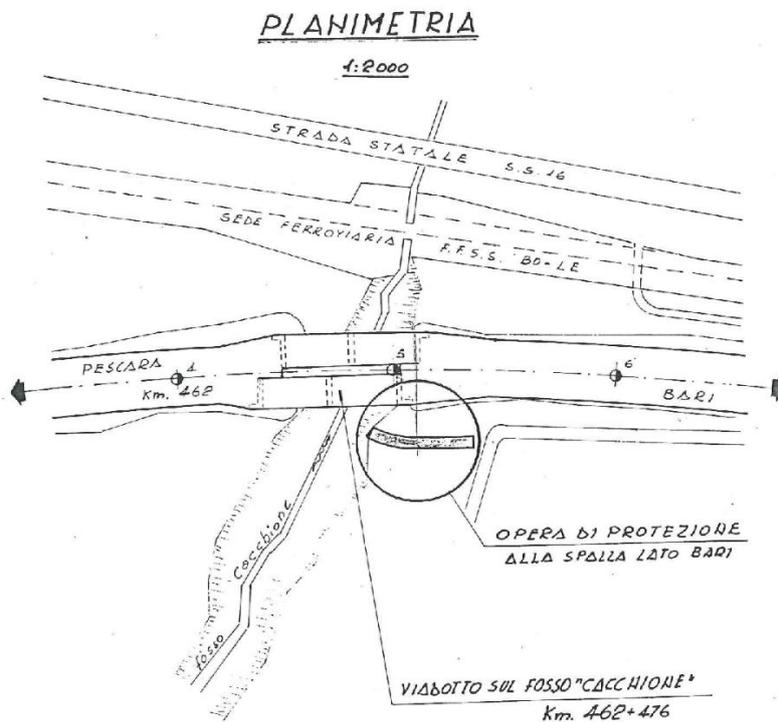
Viadotto Cacchione – Paratia di pali a protezione delle Spalle lato Bari - Inquadramento (Doc.Ref.[7] e [18])
